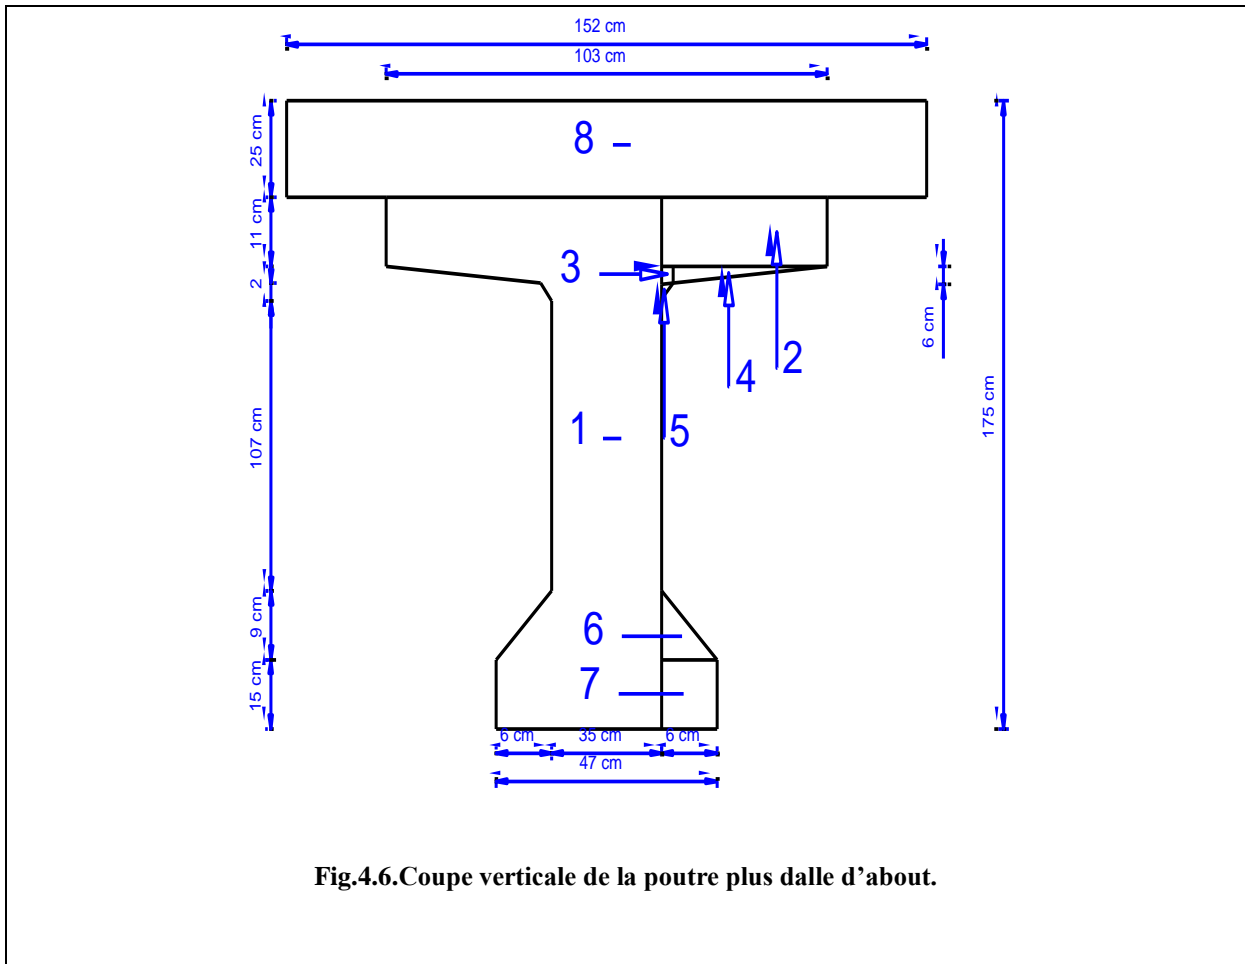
Coupe verticale de la poutre plus dalle d'about.
